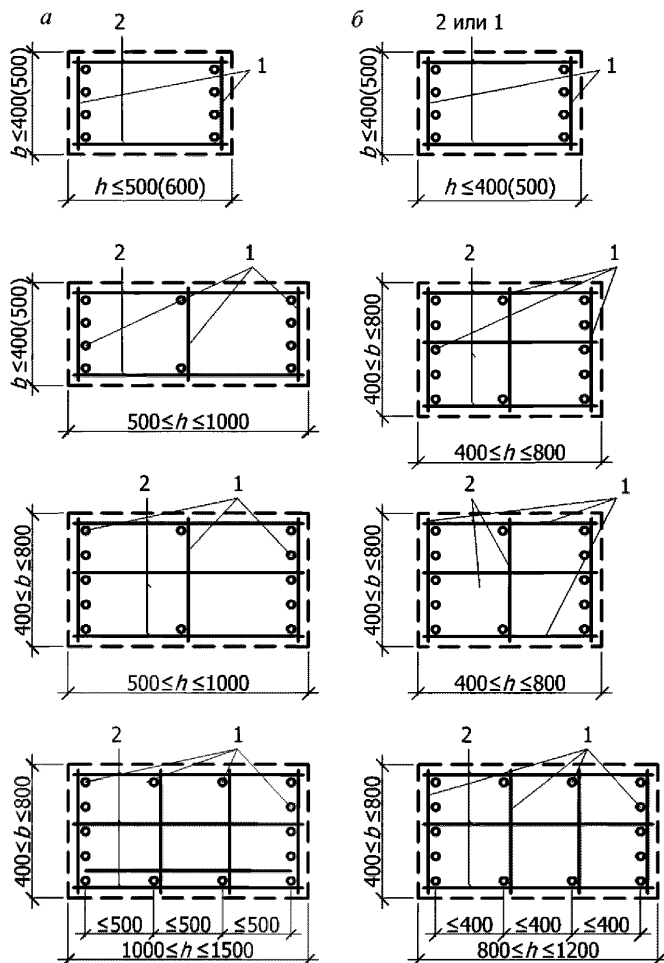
Пространственные арматурные каркасы без промежуточных стержней
